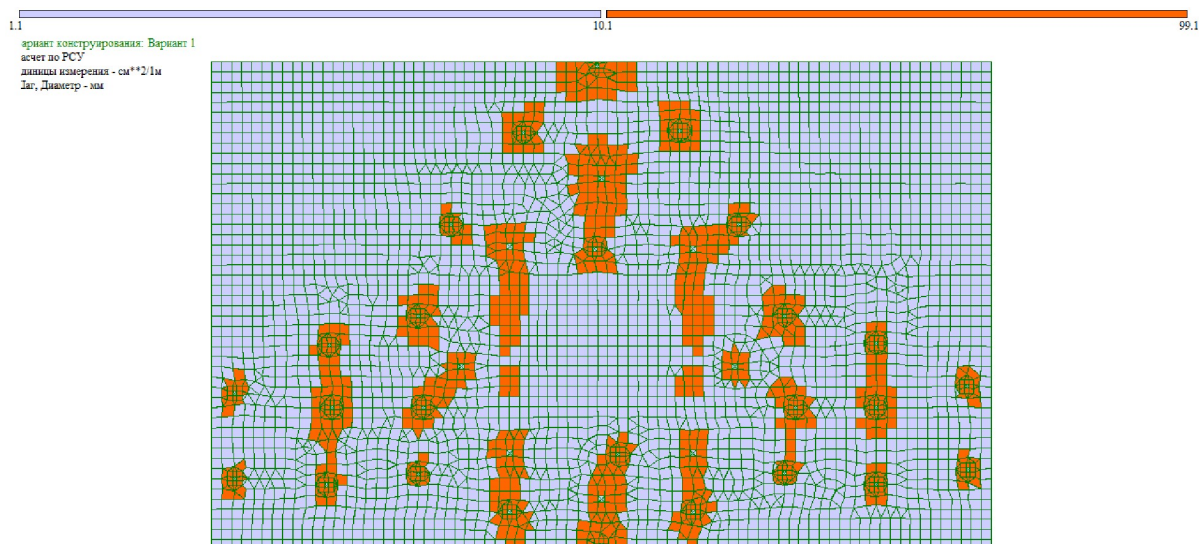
Армування фундаментної плити (Нижня по X)
